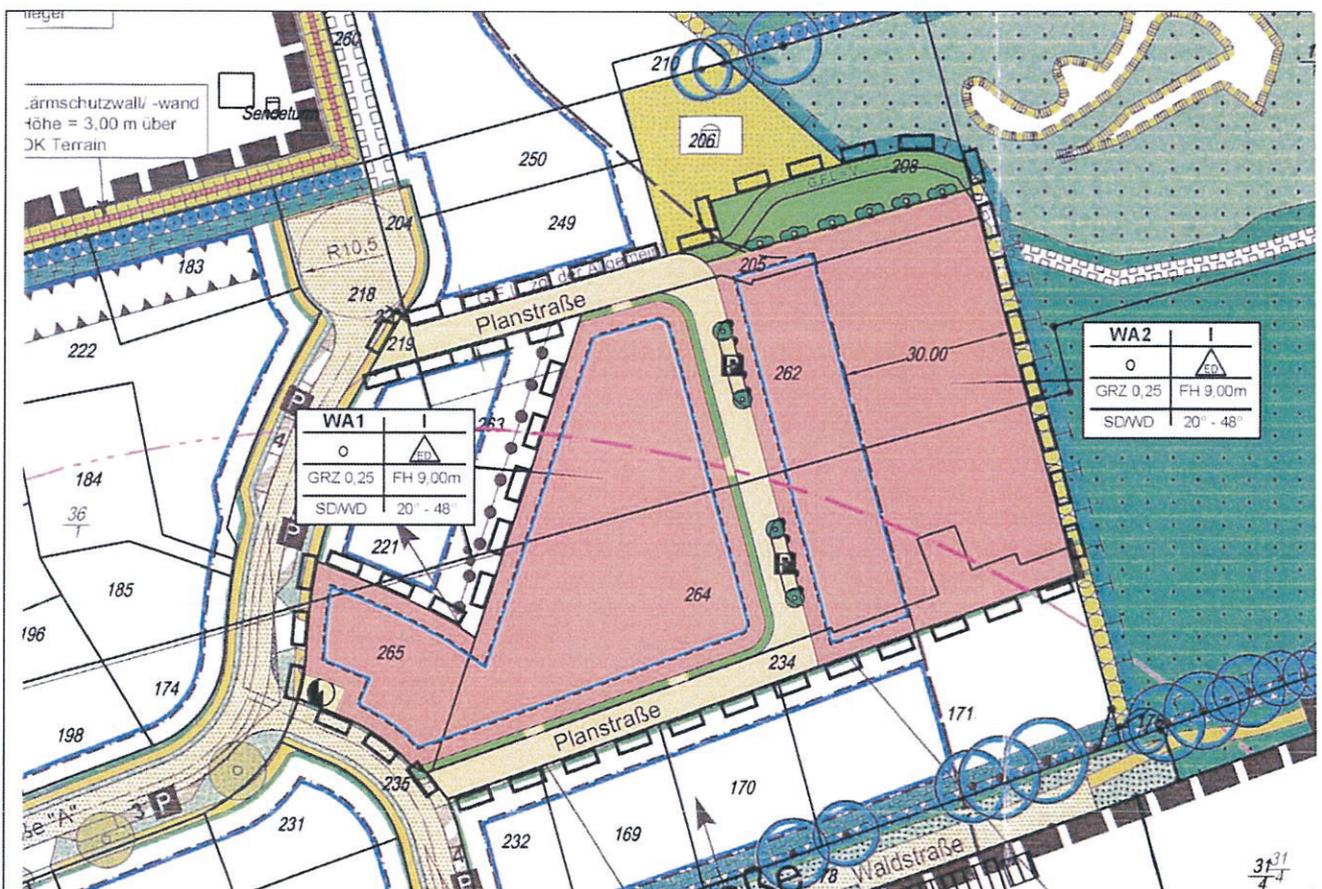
Lageplan – Änderung der vormaligen MI-Gebiete zu WA-Gebieten (WA 1 und WA 2)
